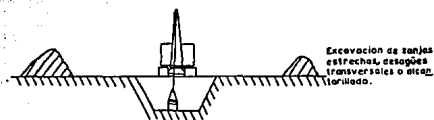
Actividades apropiadas para las dragas de arrastre.
